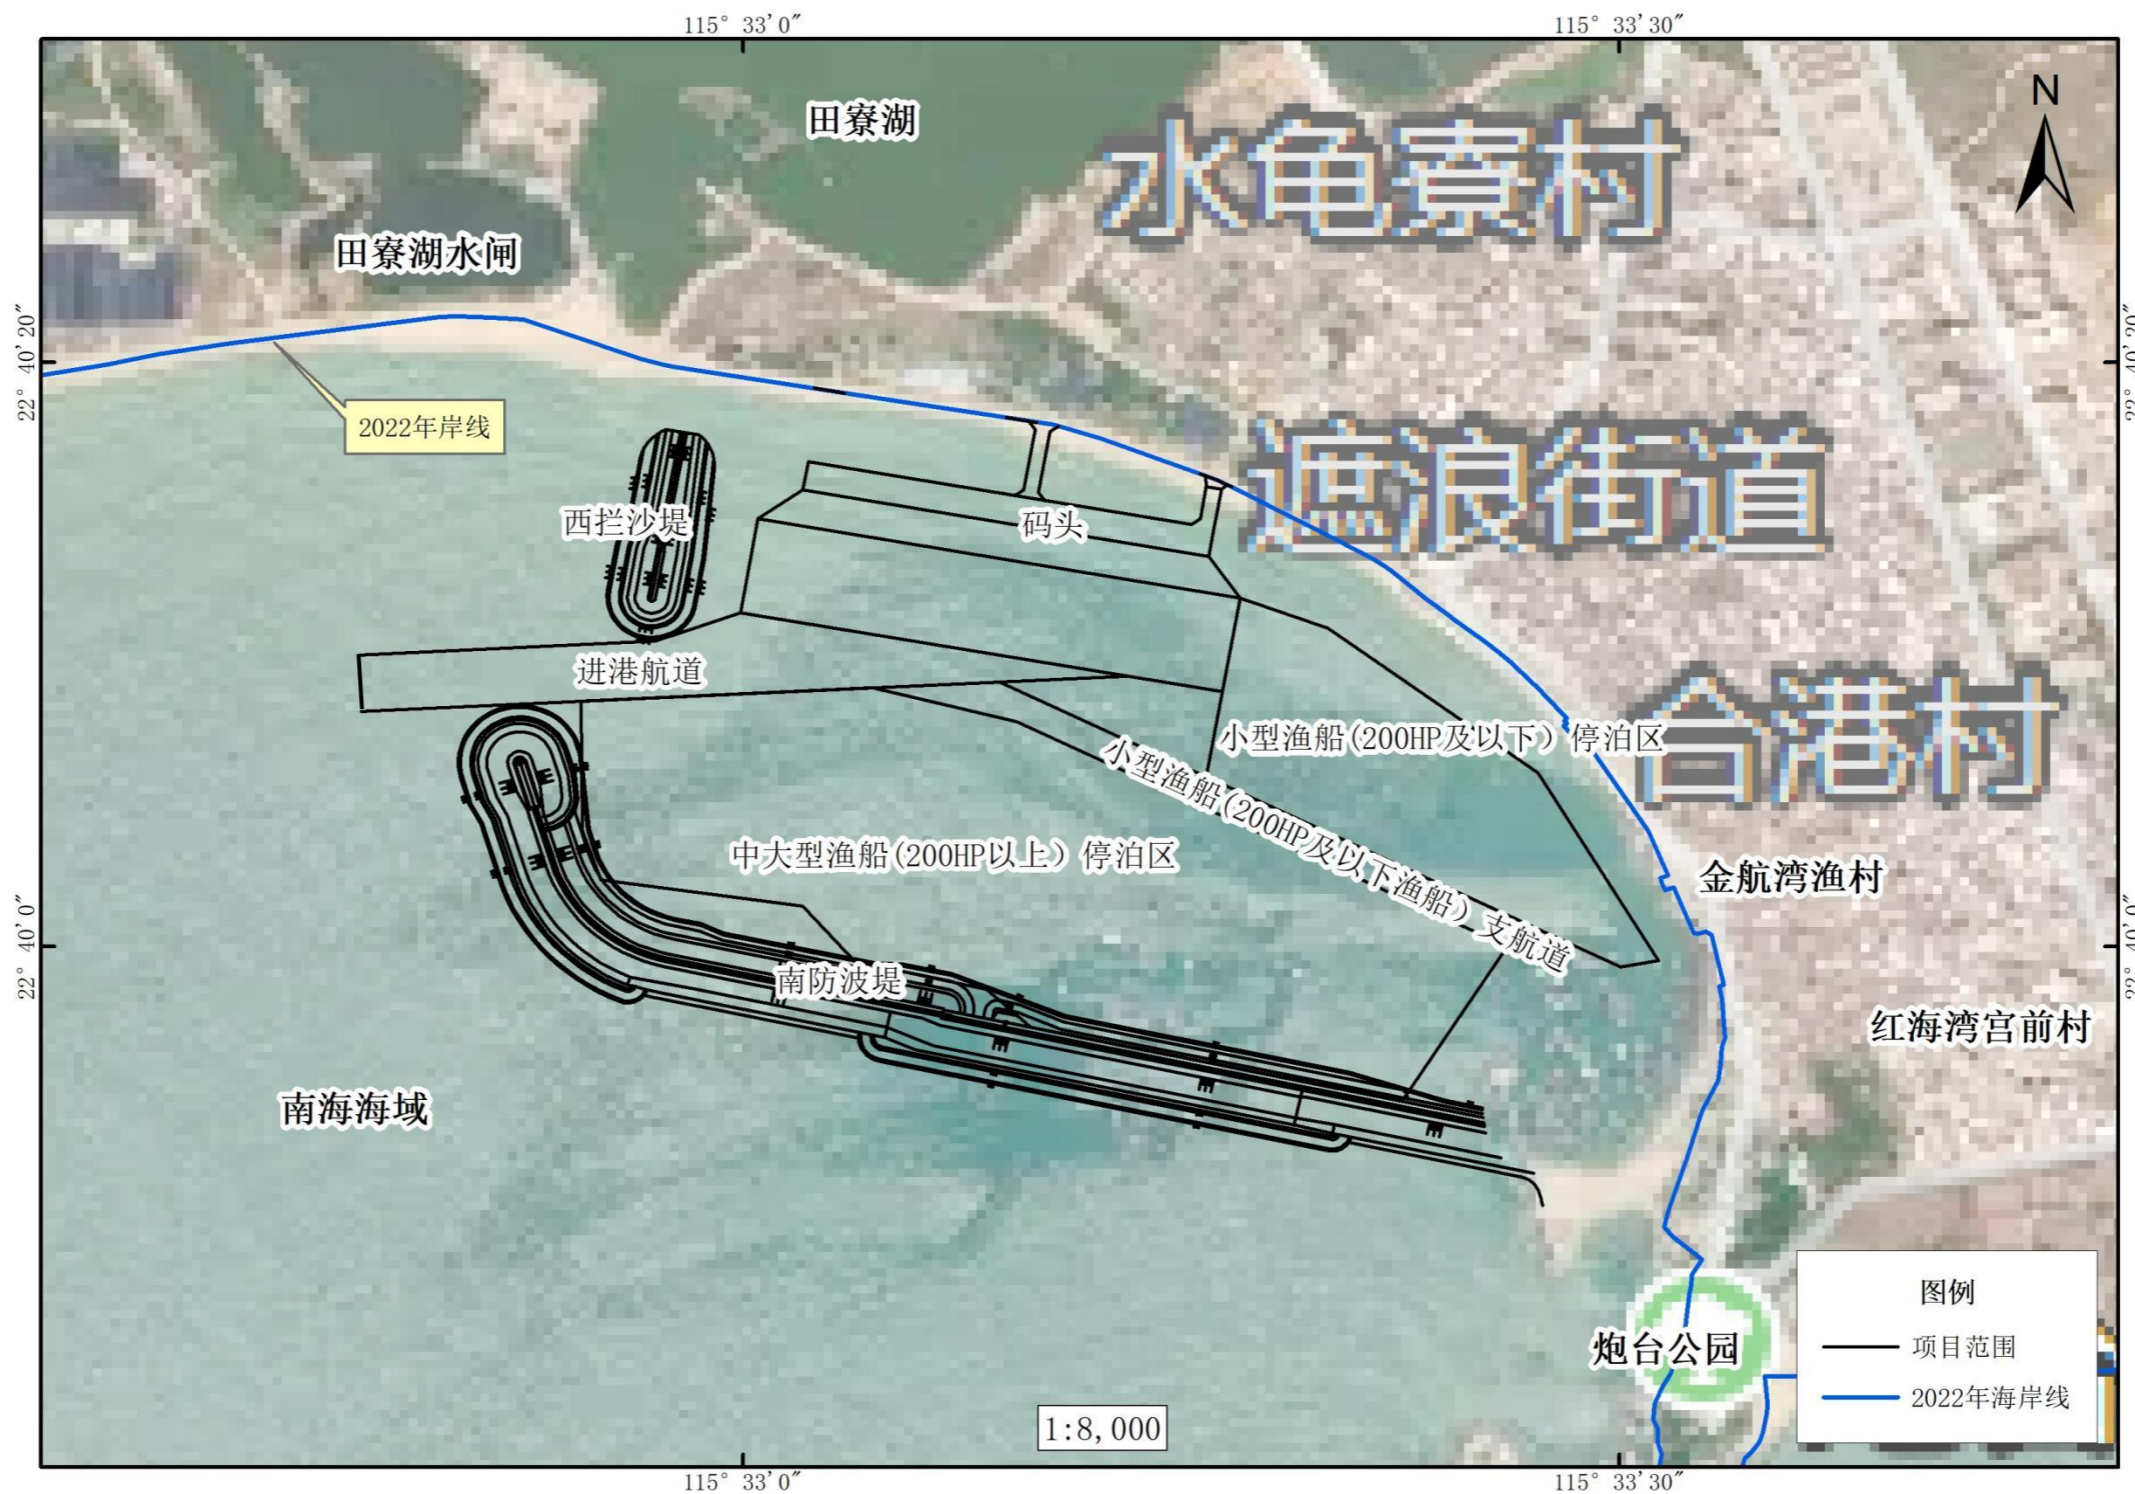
本项目平面布置与 2022 年岸线位置关系图
